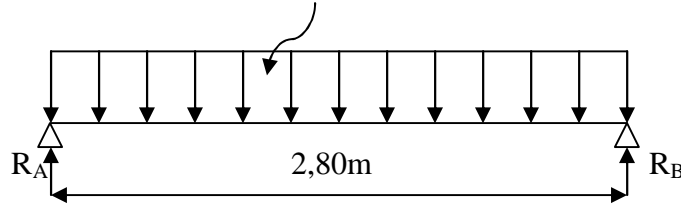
Schéma statique de la poutre palière.' ELU.
